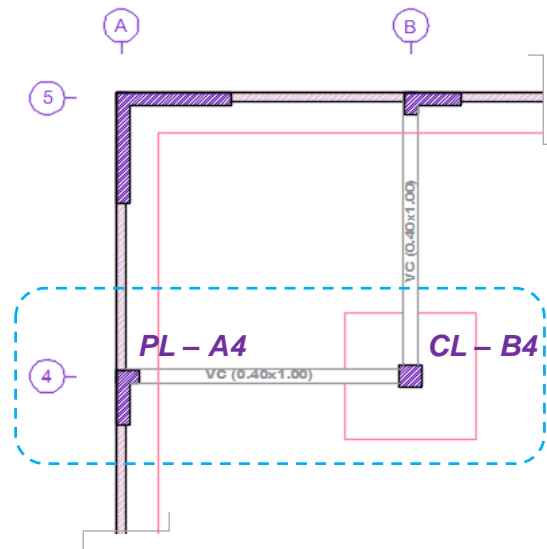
Zapata conectada, PL – A4 y CL – B4.
